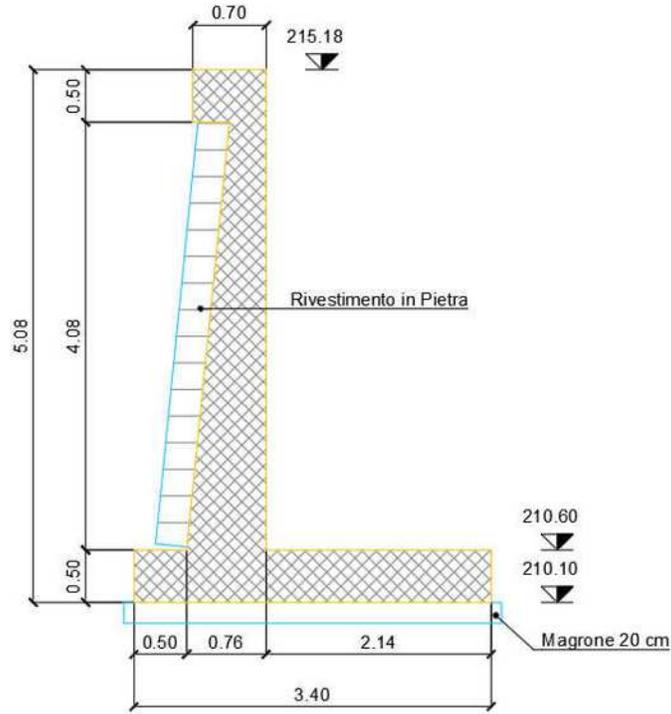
Muro V.OP-04 – Sezione trasversale
